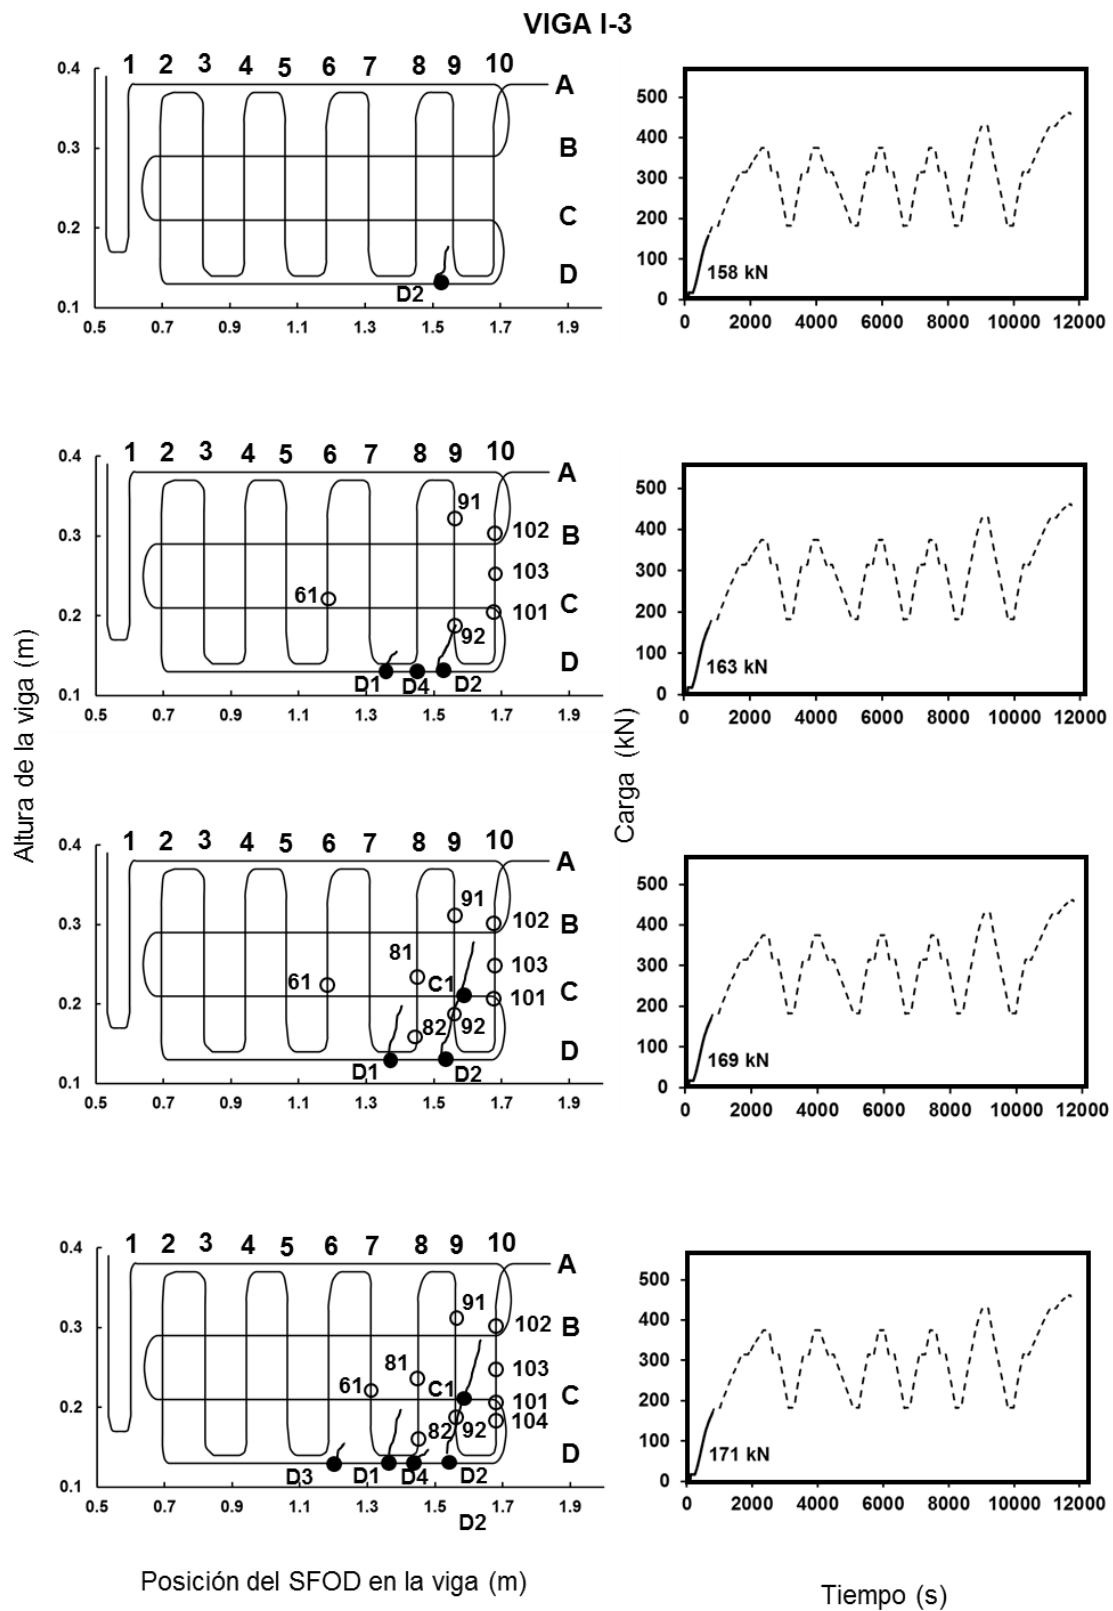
Patrones de fisuración de la viga I-3 (158 a 171 kN)
